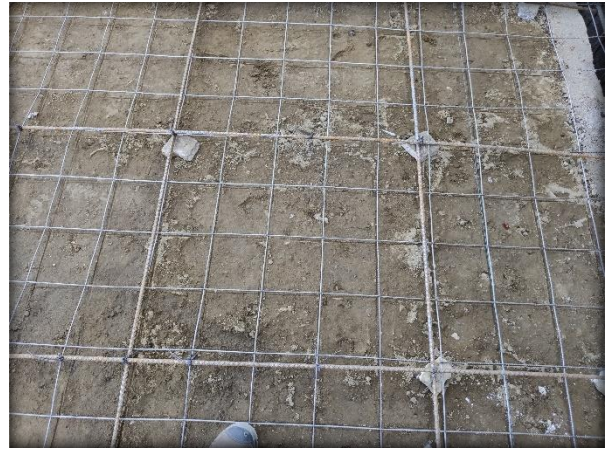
Armado de losa de Cimentación. Elaboración Propia.
